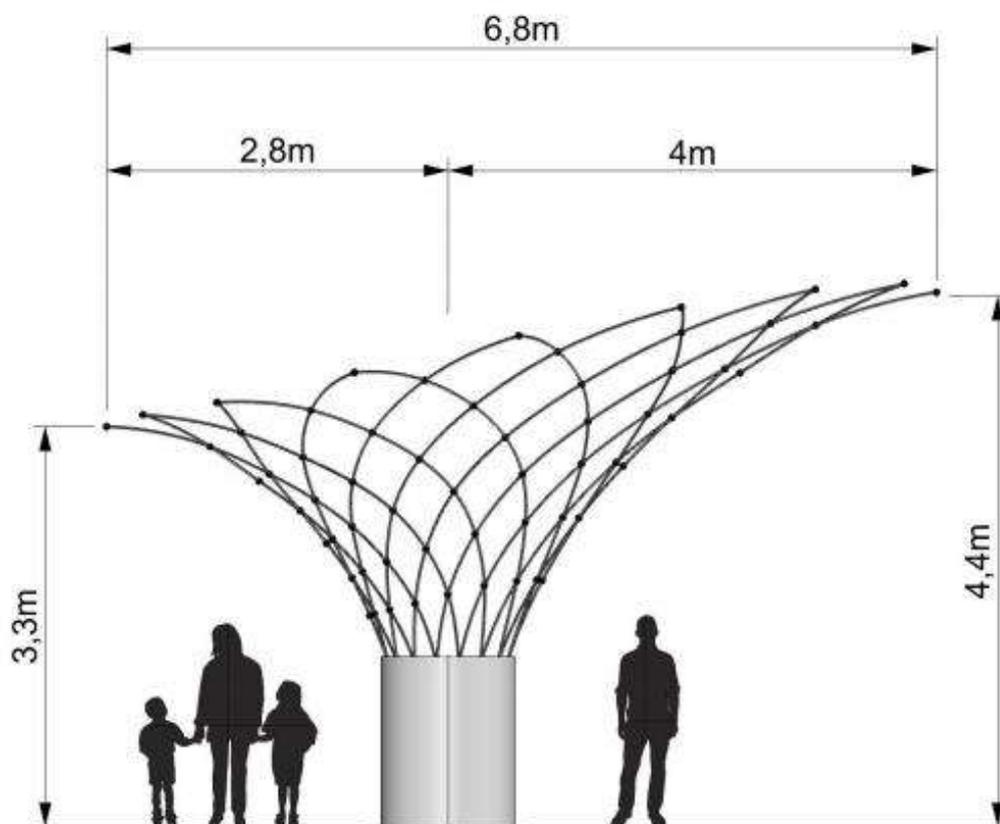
Dimensions de la Corolle Asymétrique, vue de face
